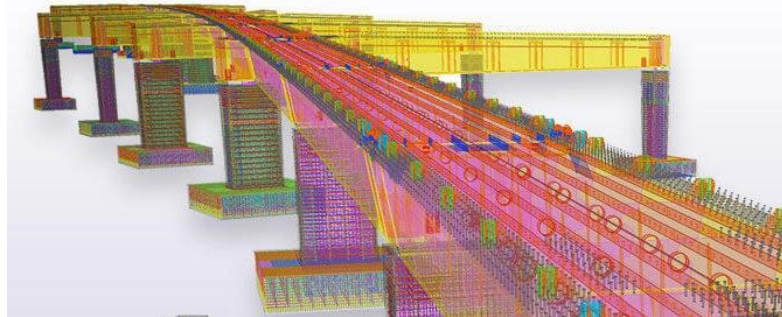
Ingeniería de detalle de acero de refuerzo en puentes
